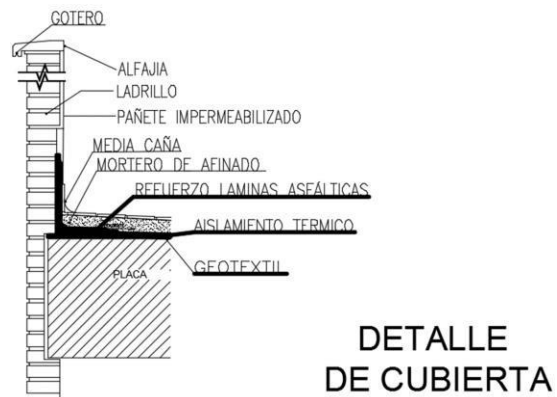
Detalle de Cubierta, Instituto de aprendizaje técnico de Leyva
